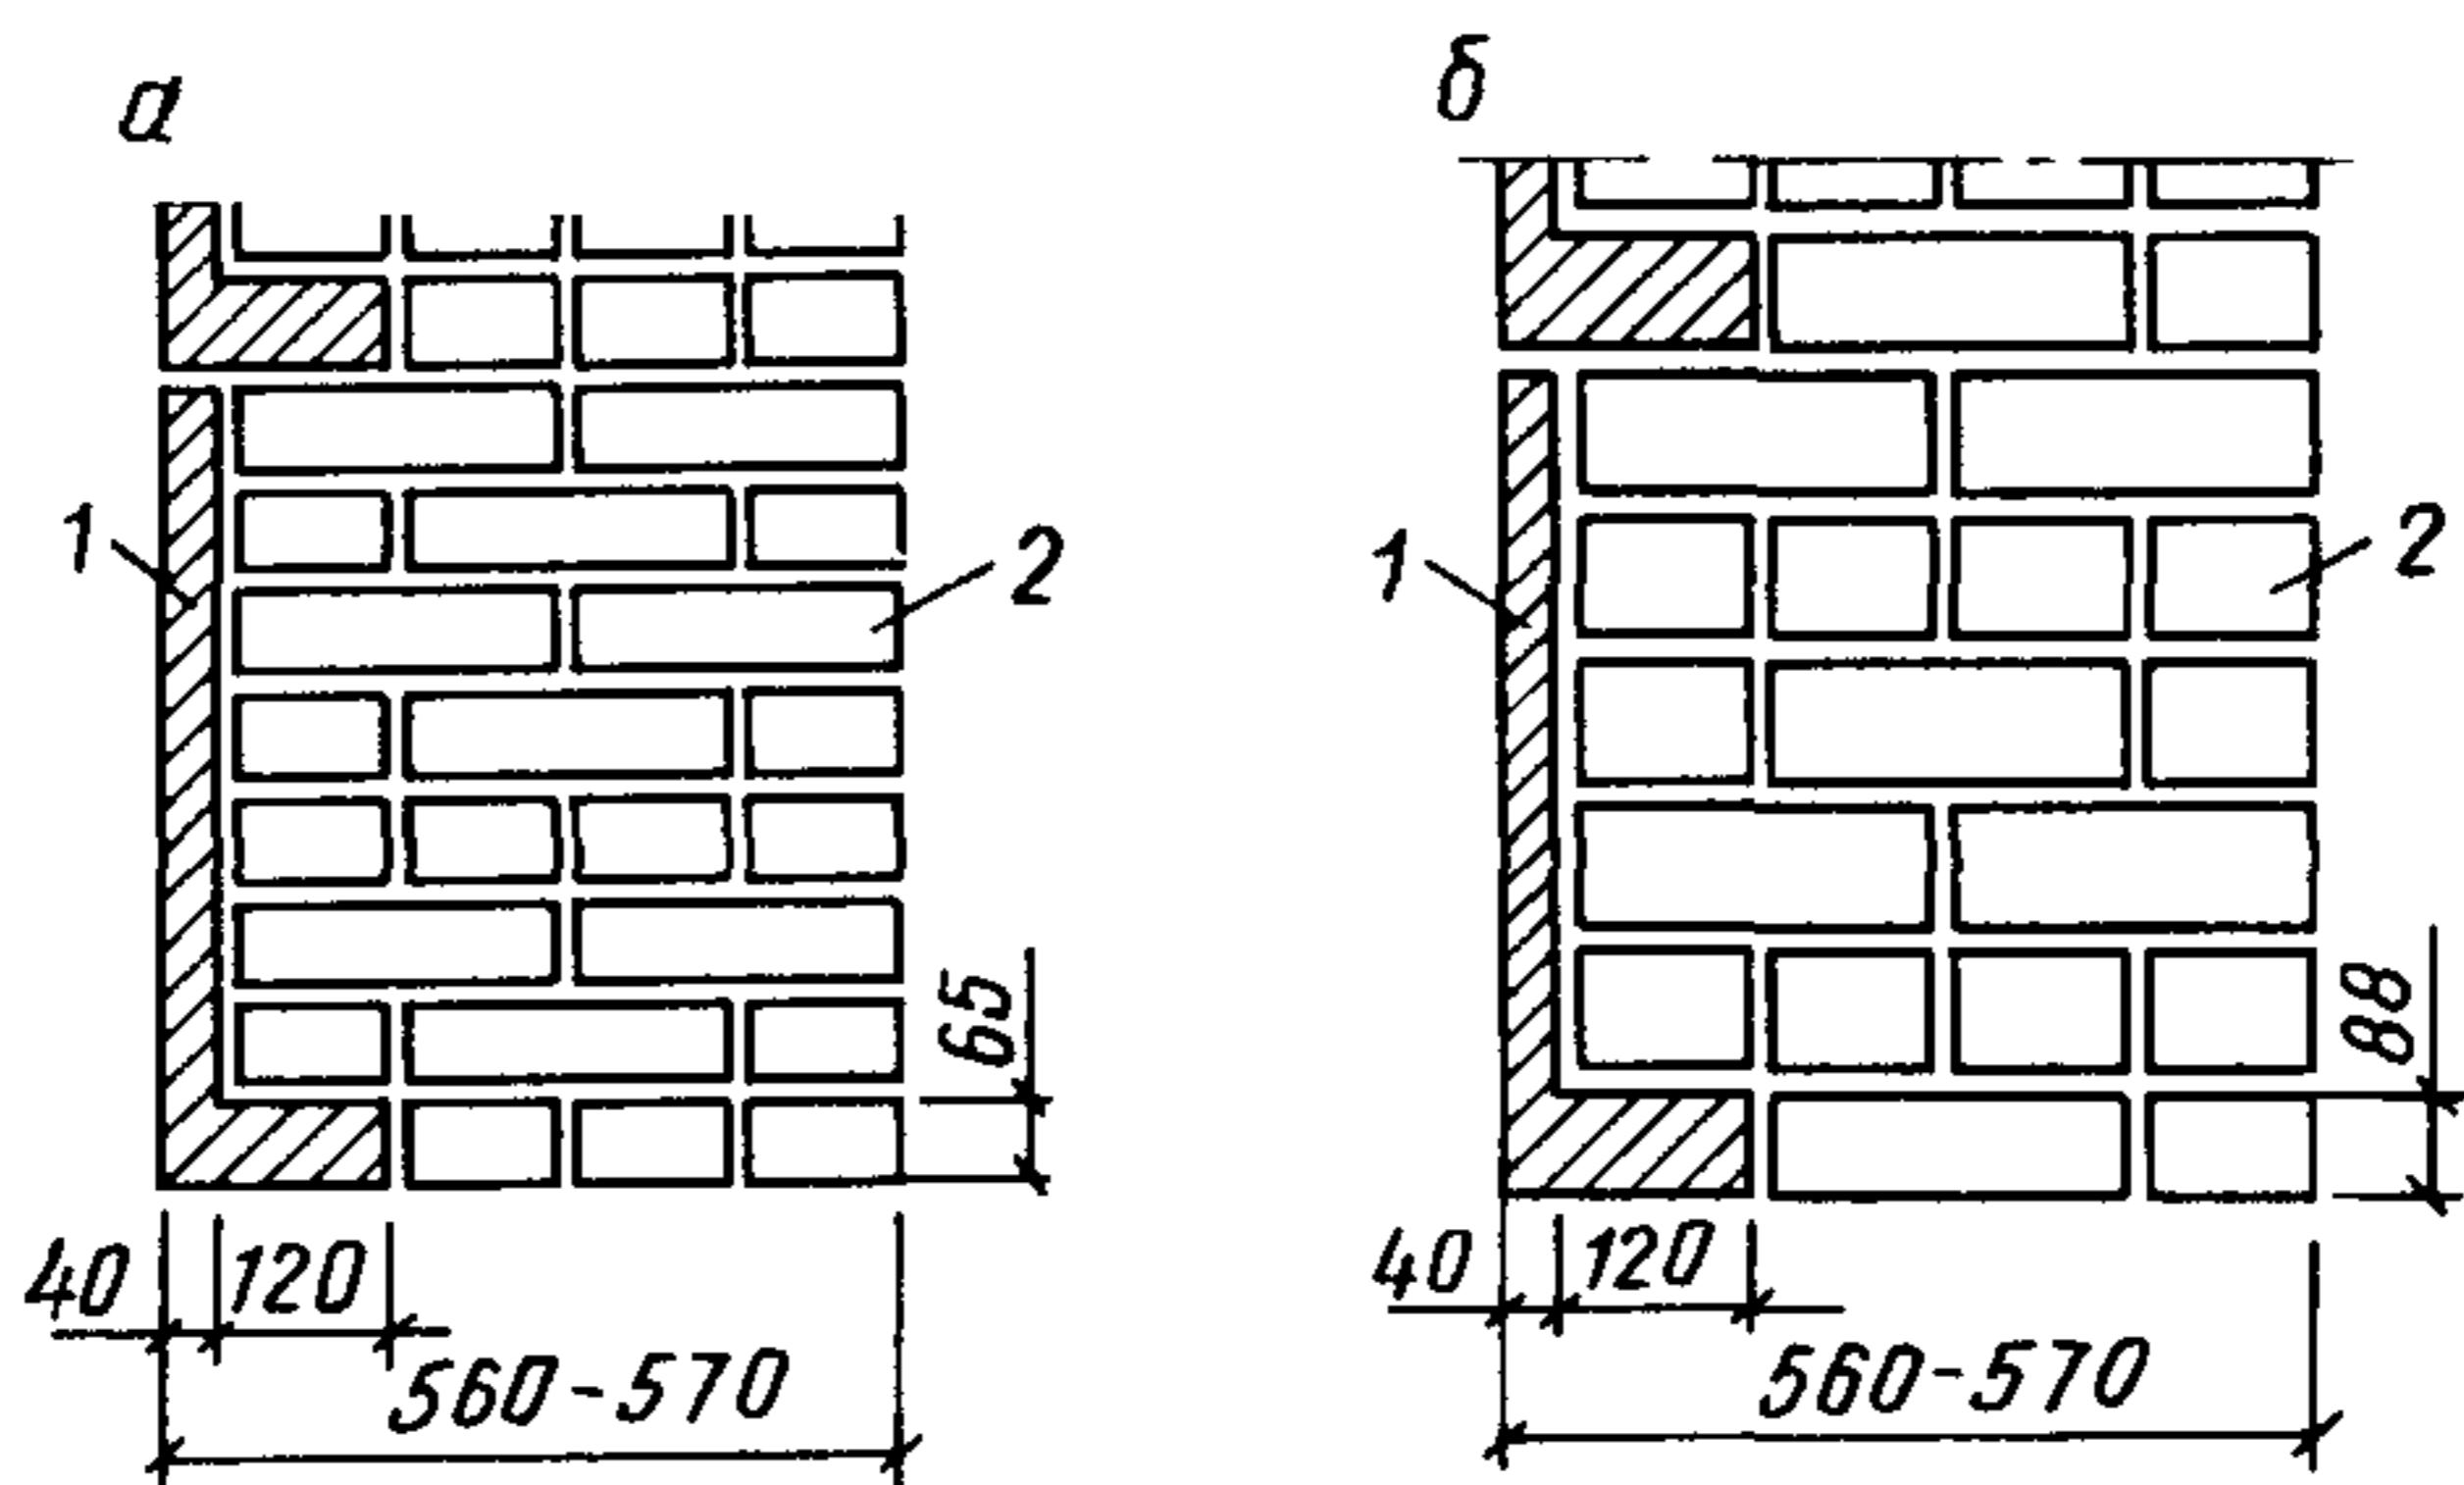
Облицовка стен зданий Г-образными закладными бетонными плитами
